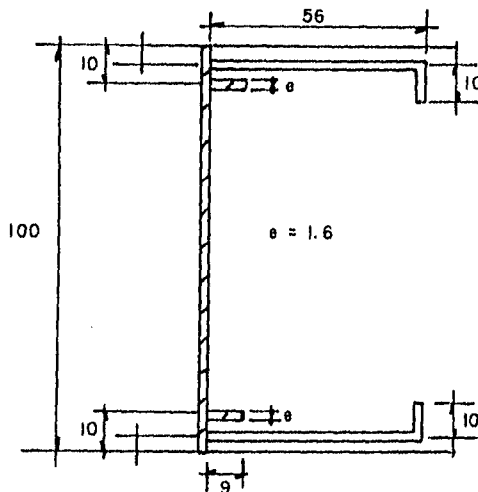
Detalle de la placa de acero utilizada en las columnas tipo "D"
